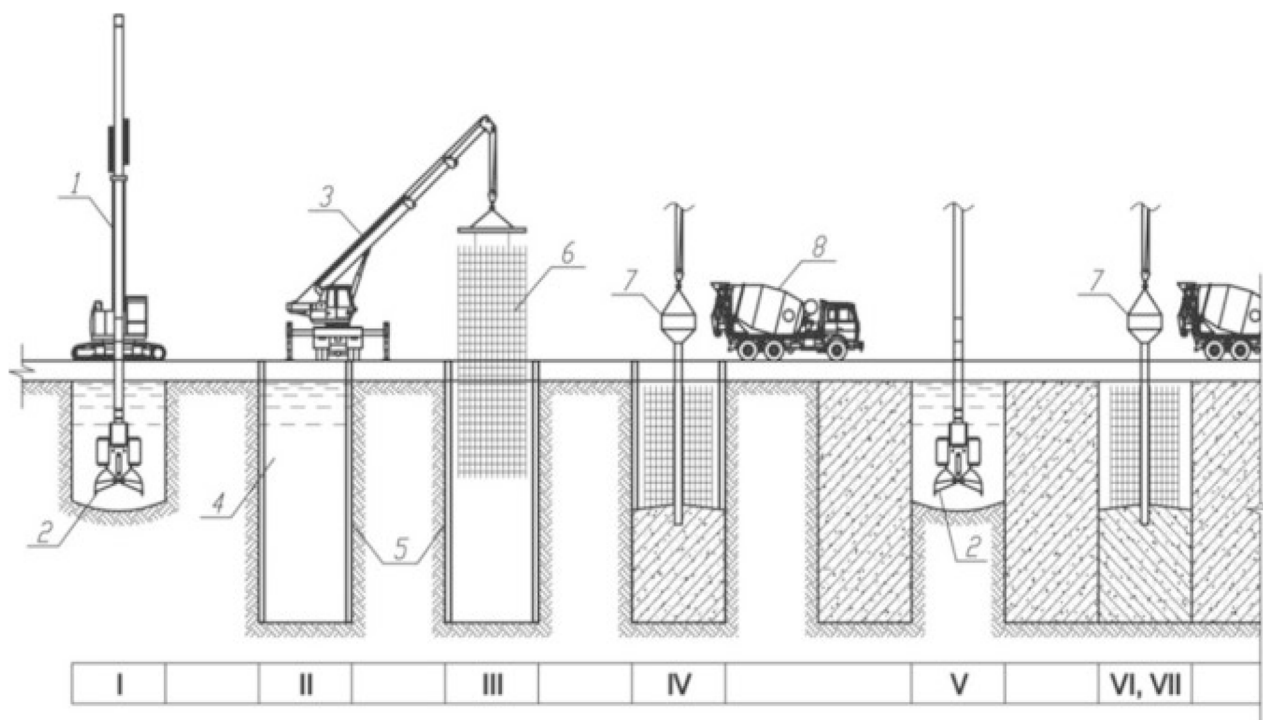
Технологическая схема возведения монолитной «стены в грунте»: I – разработка грунта под глинистым раствором; II – опускание разделительных элементов; III – установка арматурных каркасов; IV – бетонирование стены и извлечение ограничителей; V – разработка грунтовых целиков; VI – установка арматурных каркасов; VII – бетонирование стены; 1 – жесткая штанга; 2 – грейфер; 3 – автомобильный кран; 4 – глинистый раствор; 5 – ограничители; 6 – арматурный каркас; 7 – бетонолитная труба с приемным бункером; 8 – автобетоносмеситель
